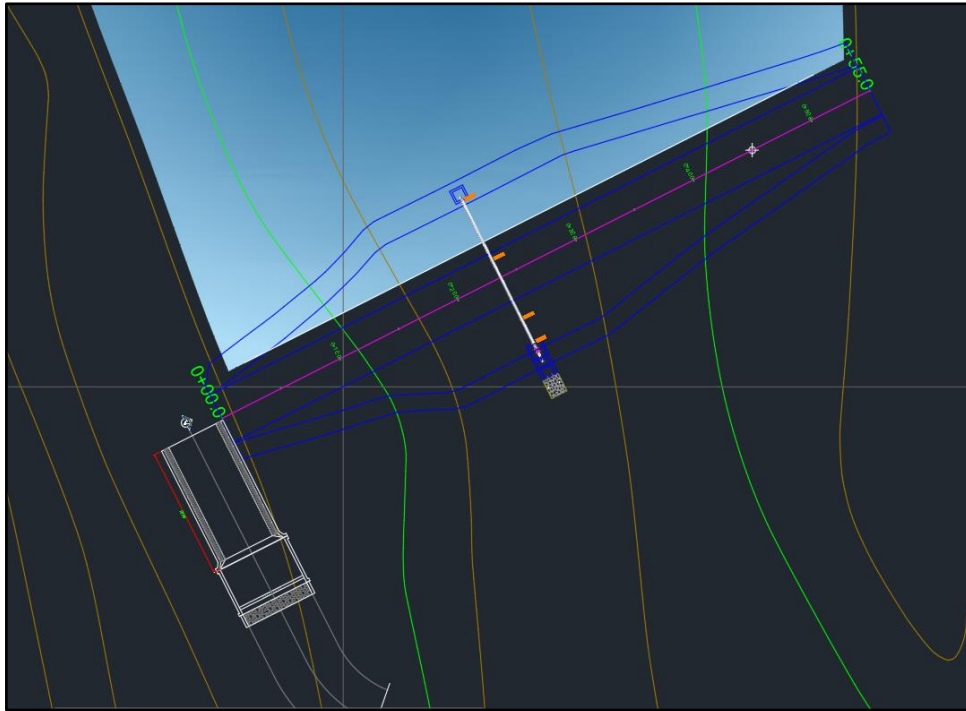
Captura del plano planta y perfil de dique (PP-01)
